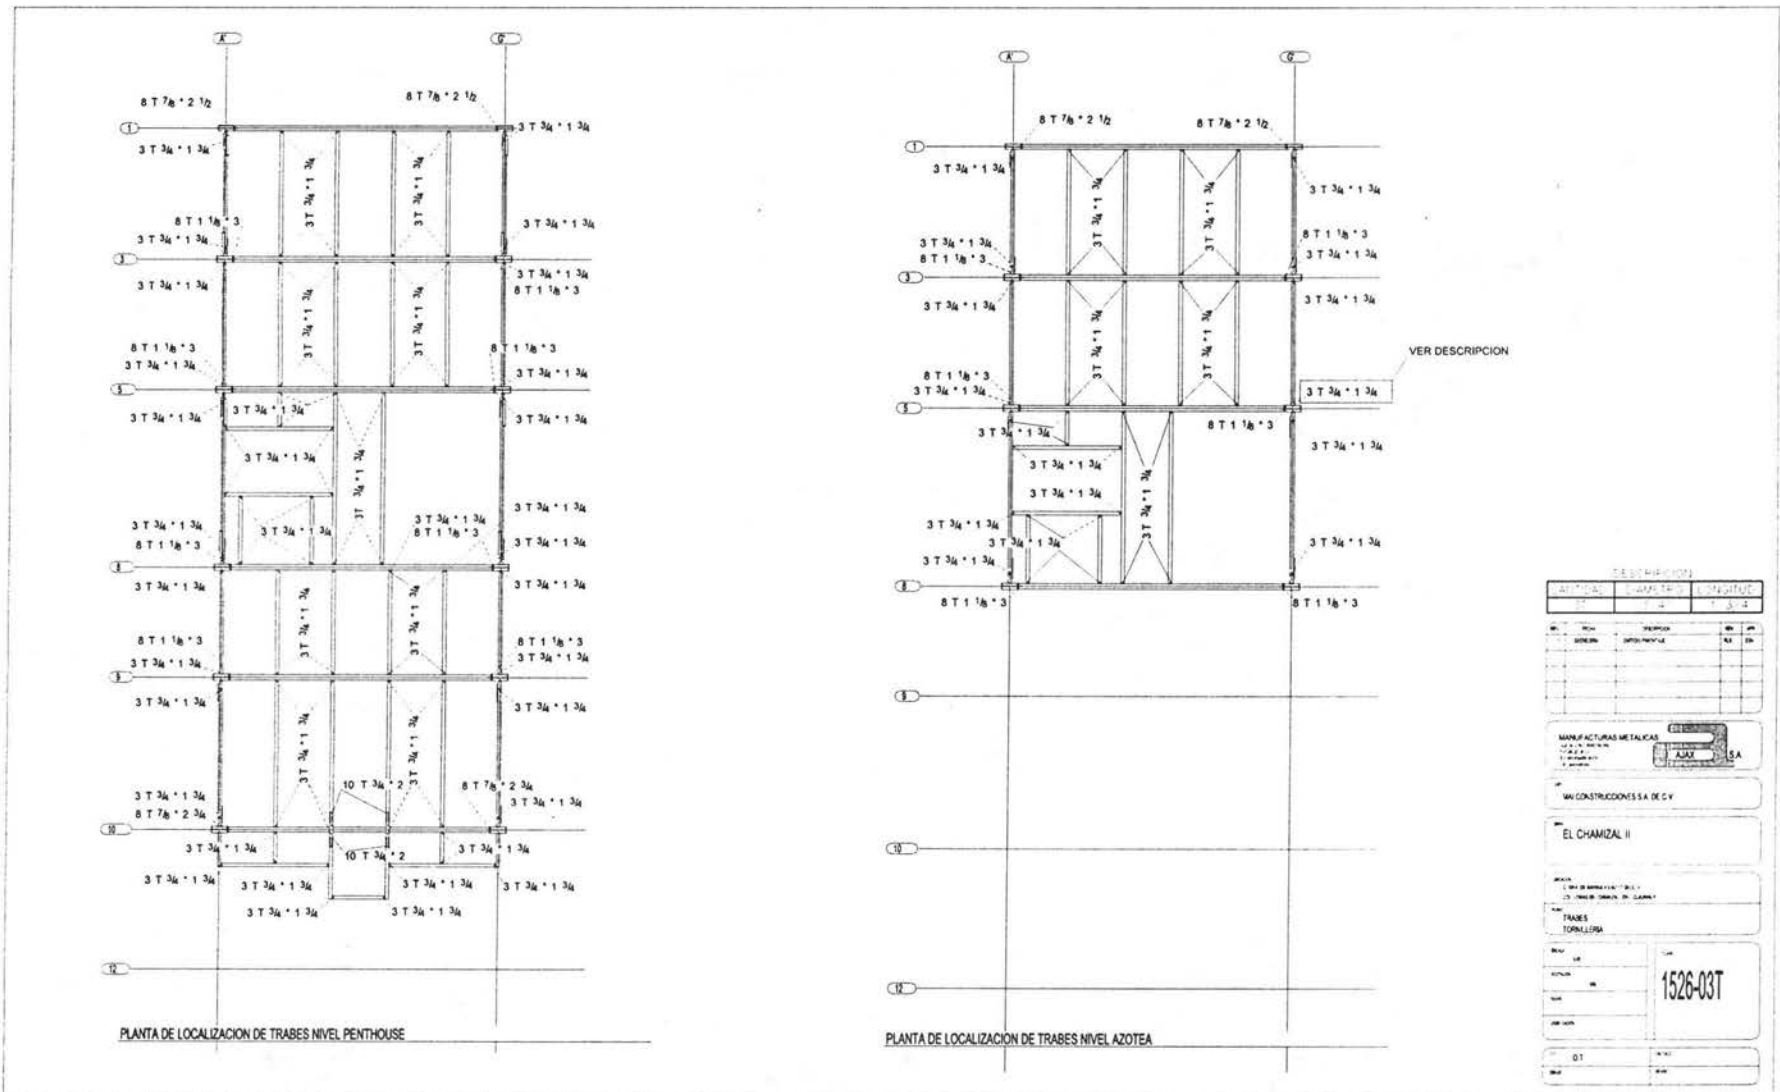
Plano de tornillería (traves penthouse y azotea).
